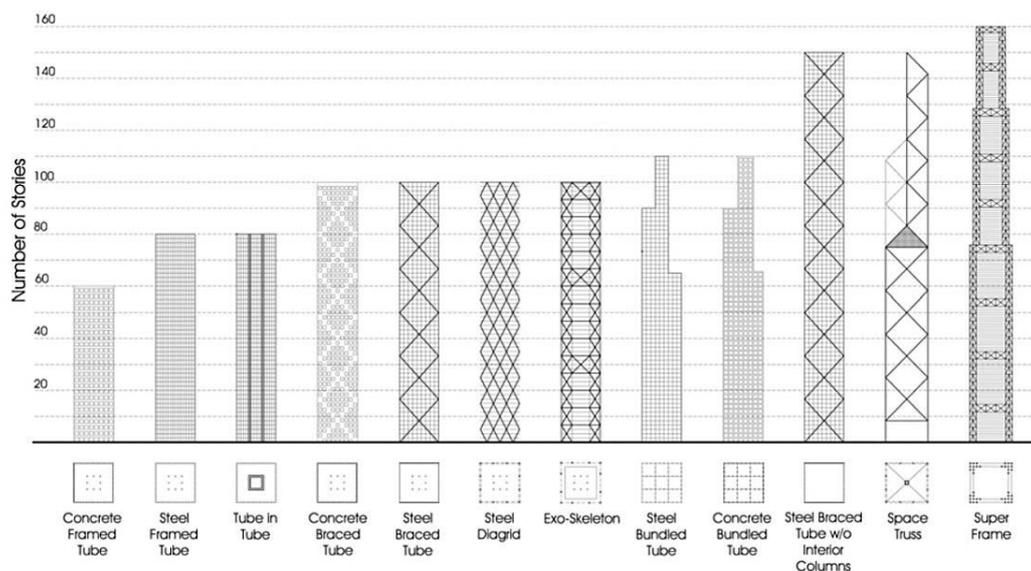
Sistema de Estrutura pela Exterior ¹⁷
